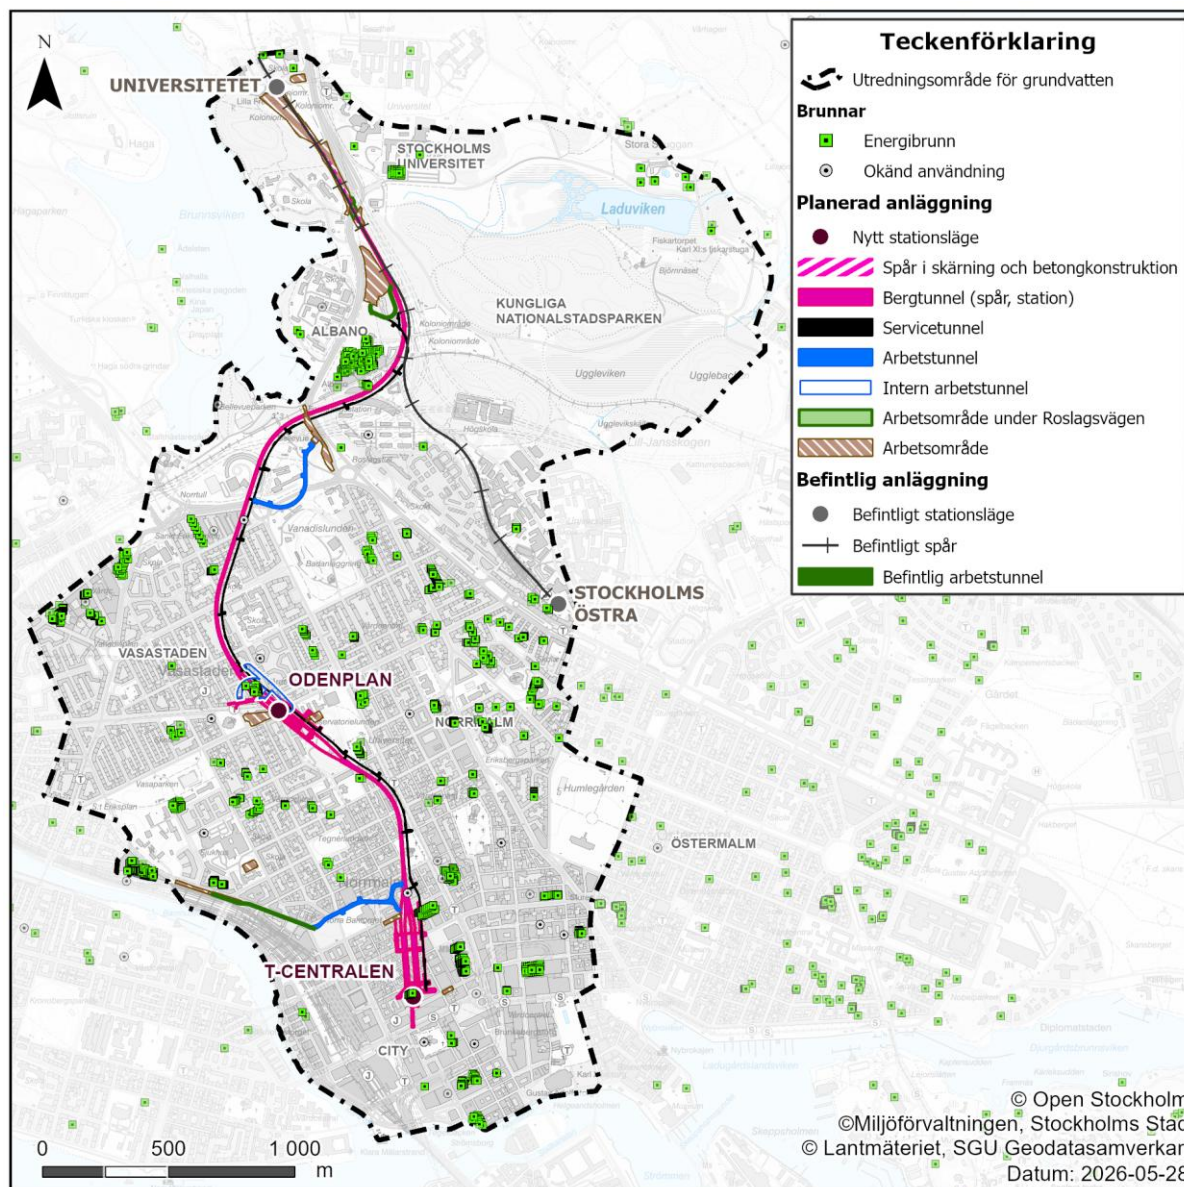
Principskiss över tunnelbyggnationens påverkan på grundvatten.
